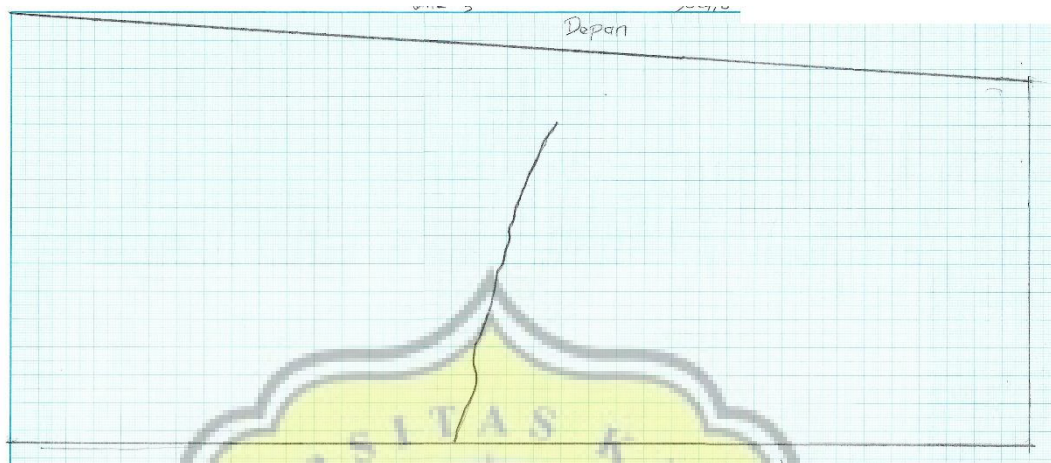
Penurunan permukaan blok beton benda uji KTB-SC-02
